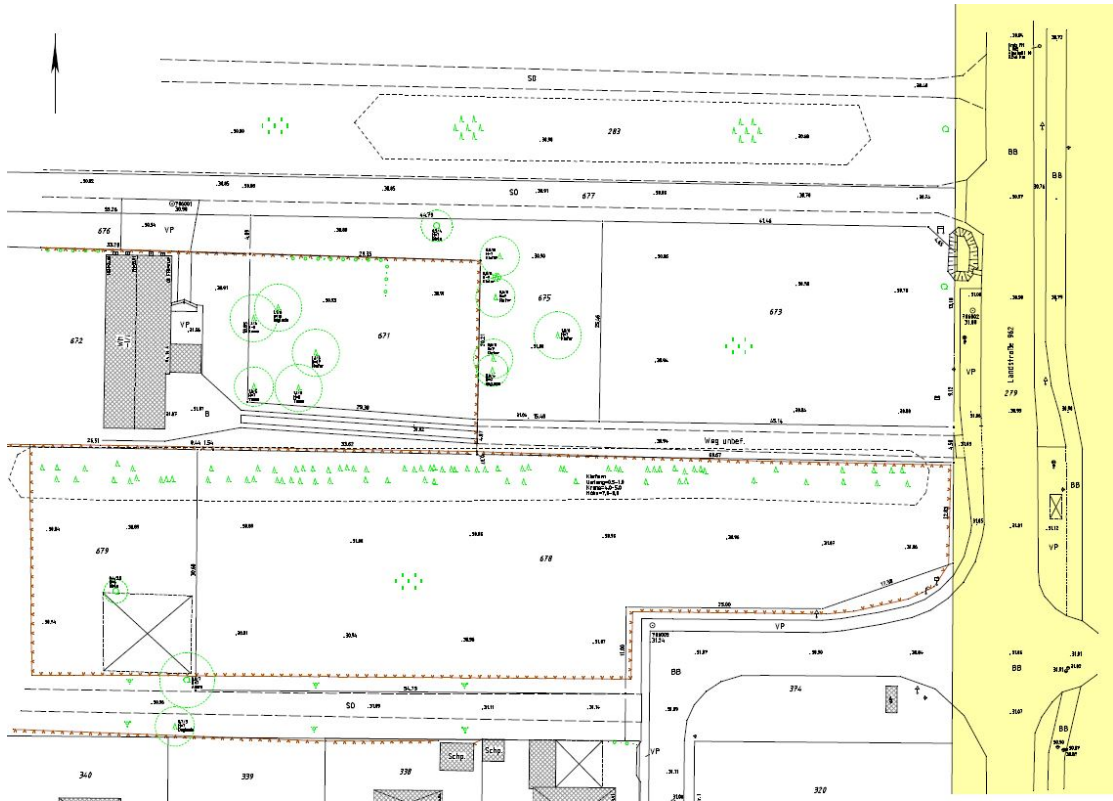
Lage- und Höhenplan, Ausschnitt,
